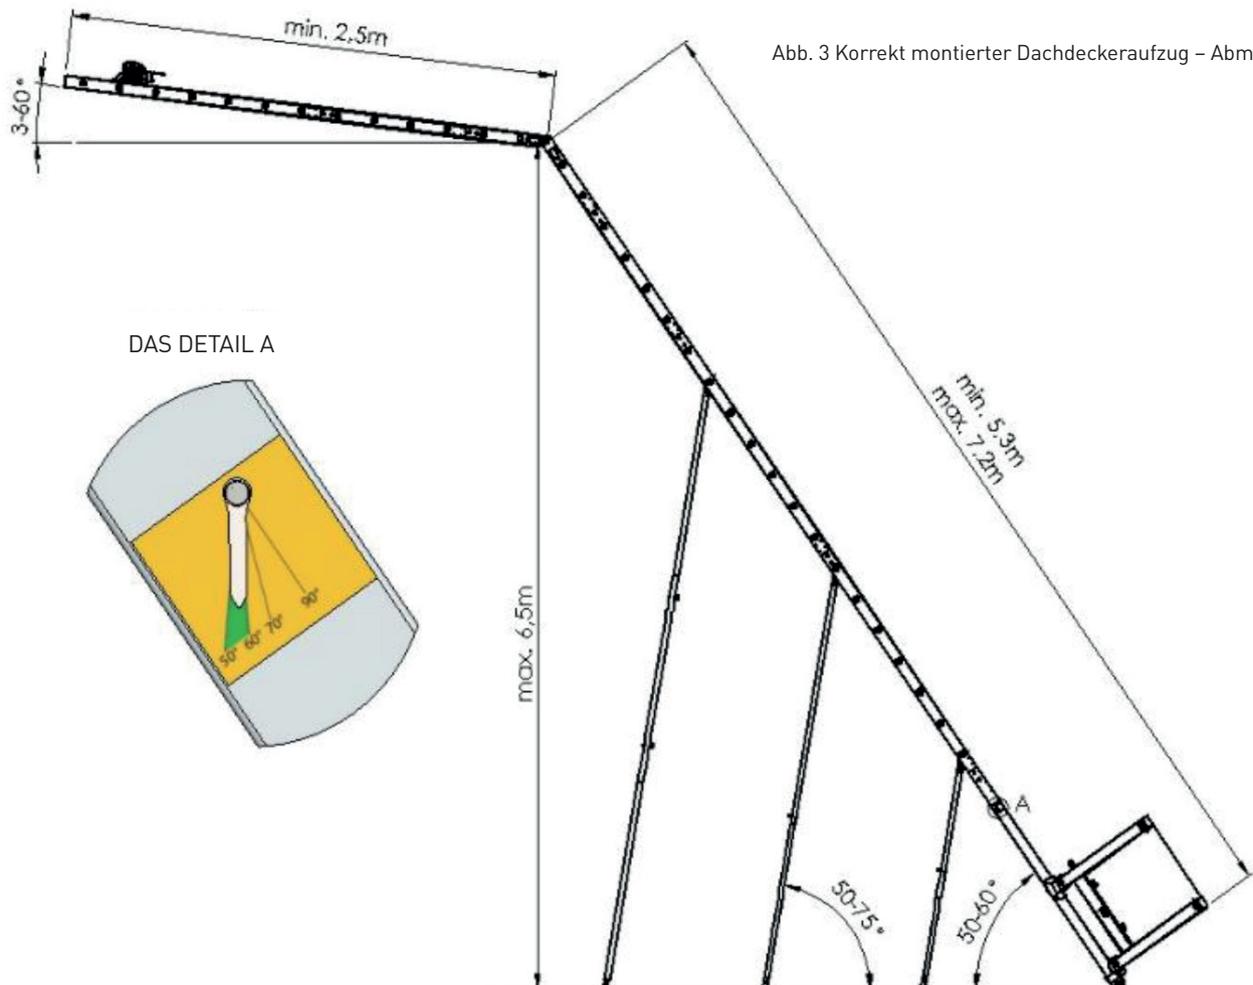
Korrekt montierter Dachdeckeraufzug – Abmessungen.
